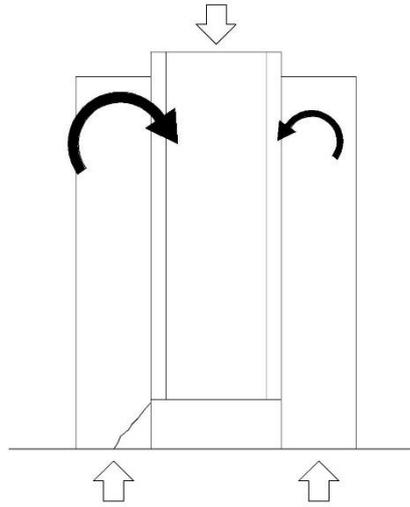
Mecanismo de surgimento da quina fissurada, por rotação maior de uma laje em relação a outra, causada por instabilidade devido a alguma excentricidade.
